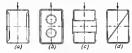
Vigas de paredes delgades da secolón rectangular con riestres transversales
